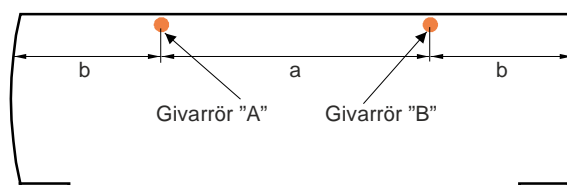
Tunnel med platt tak, mer än 3 körfiler
